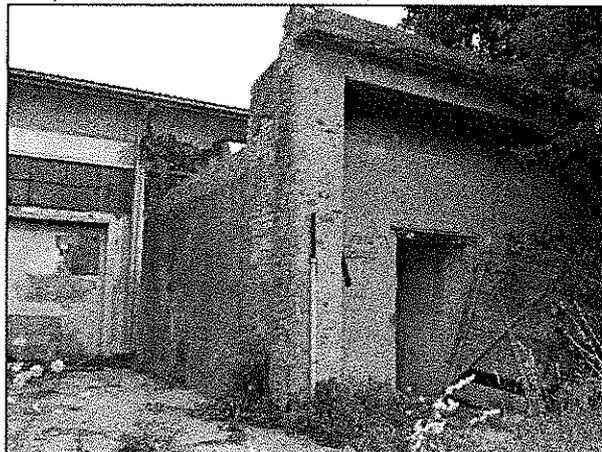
Finestre dei vani adibiti a uffici in legno e vetro singolo
